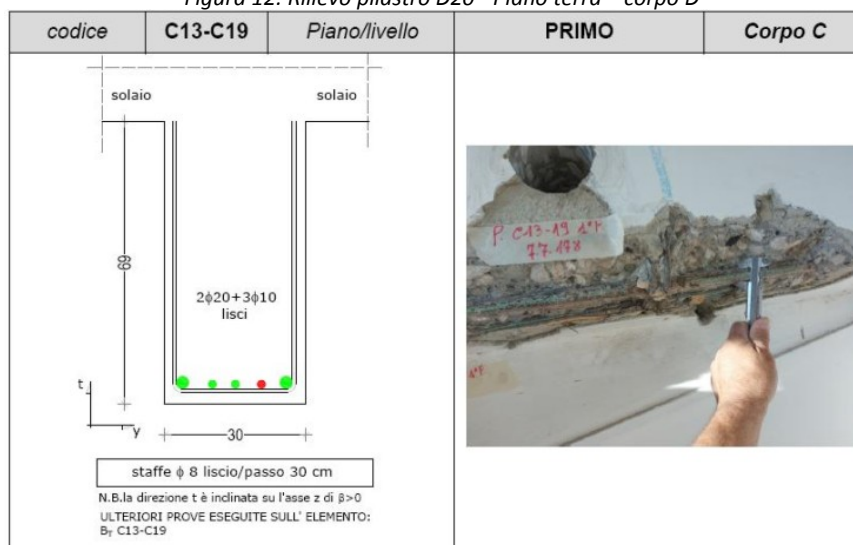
Rilievo trave C13-19 - Piano primo – corpo C
